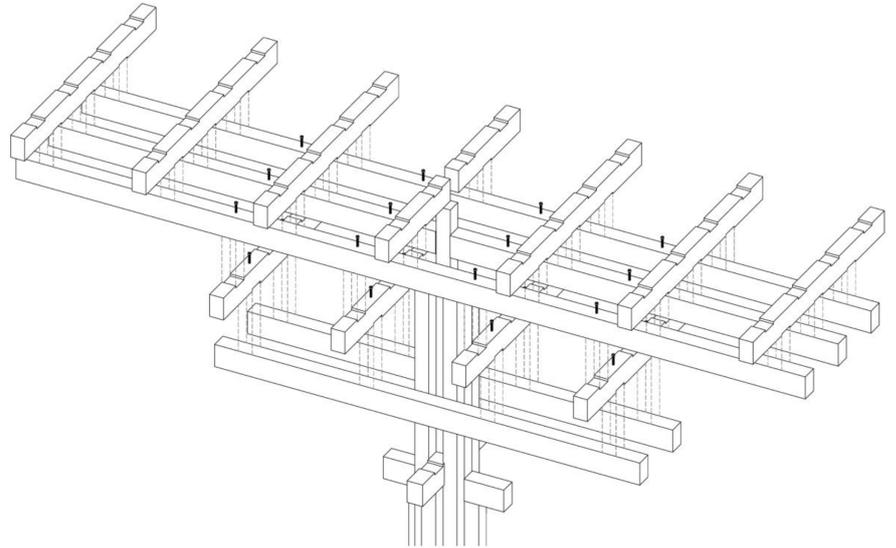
Sistema de ensamblaje entre las vigas del puente
